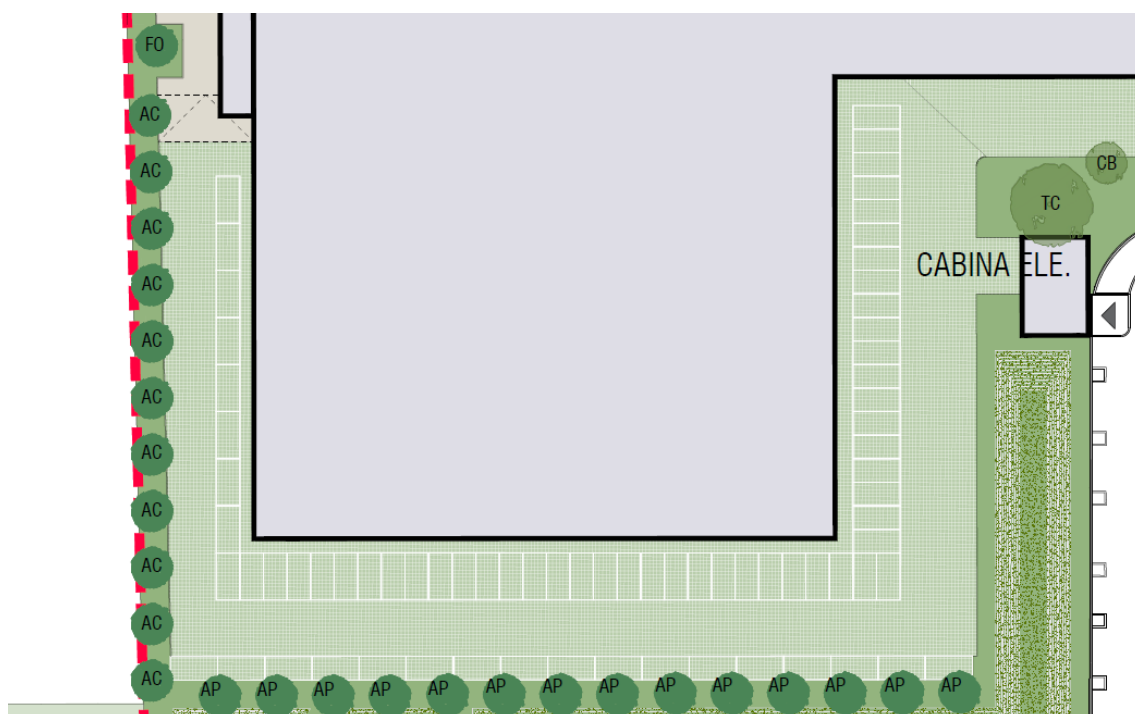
parcheggio a sud del GV4 in pavimentazione drenante
